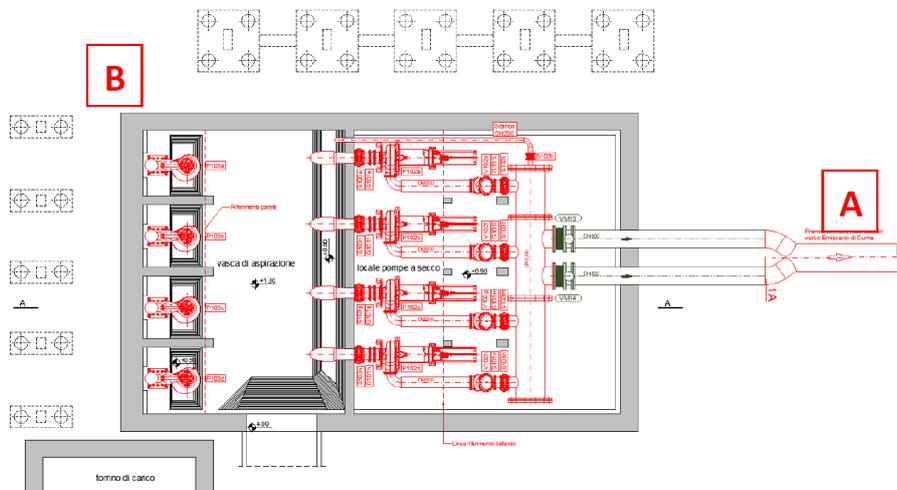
Sollevamenti all'Emissario di Cuma - Pianta piano interrato - Stato di progetto
